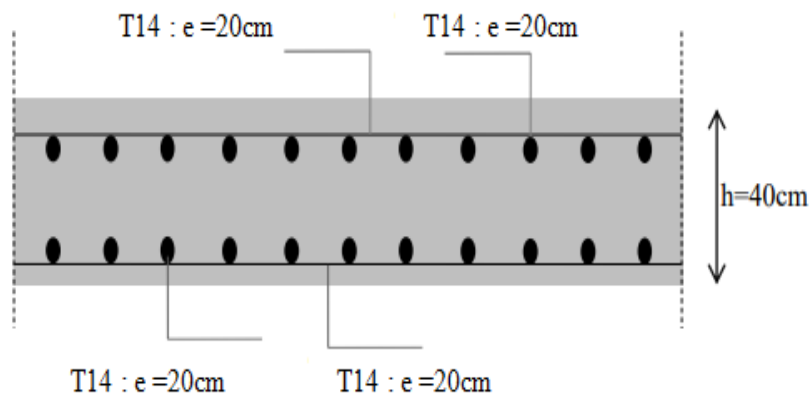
Ferrailage de la dalle du radier sens x-x .
